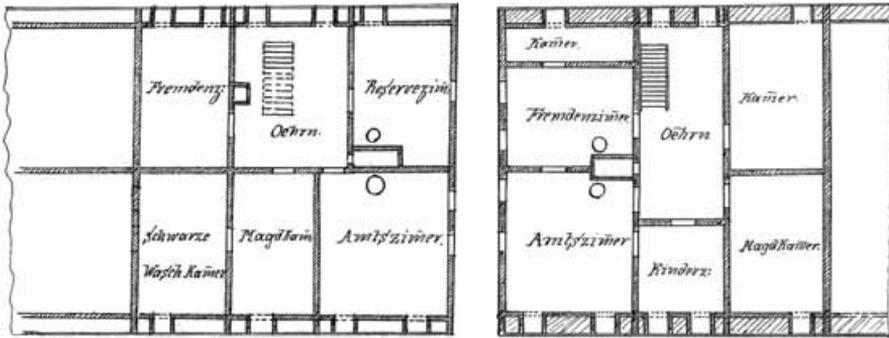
und 36: Aulberstraße 1, Planbeilage zur Baubeschreibung von 1878, Grundriss des 1. Dachgeschosses („Mansarden-Stock“), östliche und westliche Haushälfte.
